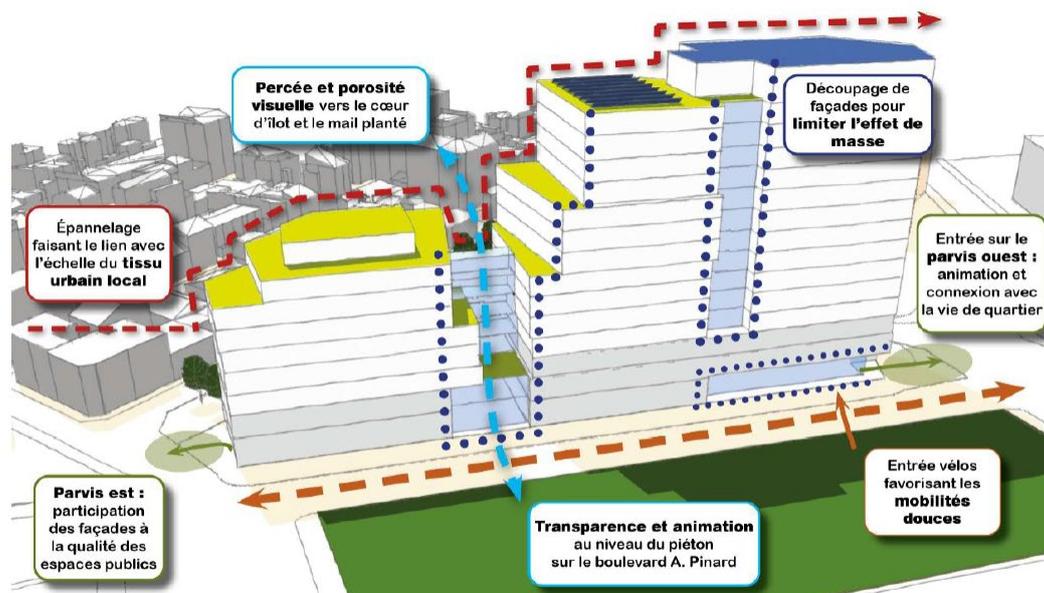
Extrait de la notice architecturale du PC montrant la fragmentation du volume bâti en alignement le long du boulevard Pinard (Agence d'architecture Viguière)
